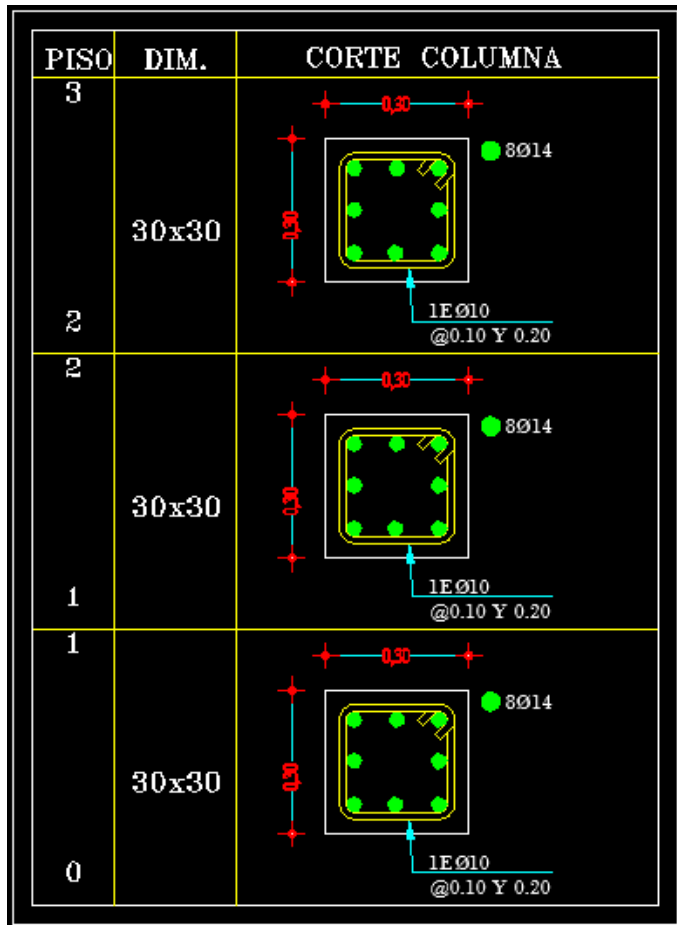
Corte típico de las columnas Edifi. 3 Pisos
